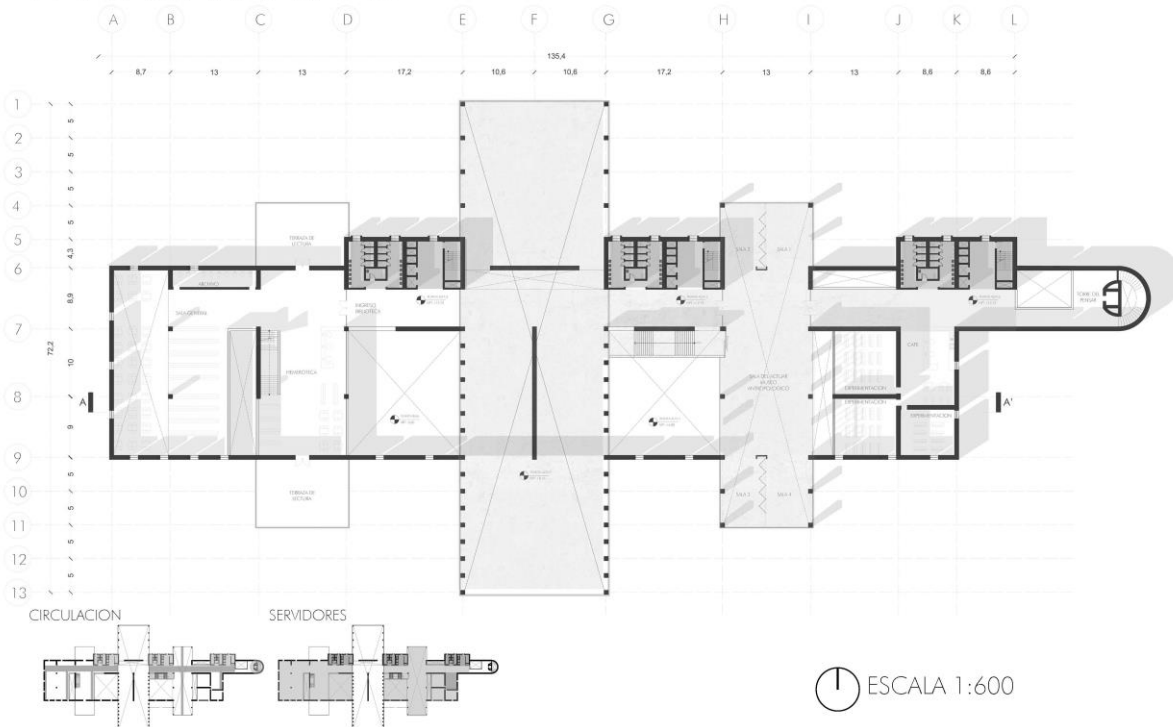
Planta Alta 3 Nivel +10.76 m Fuente: Autor
